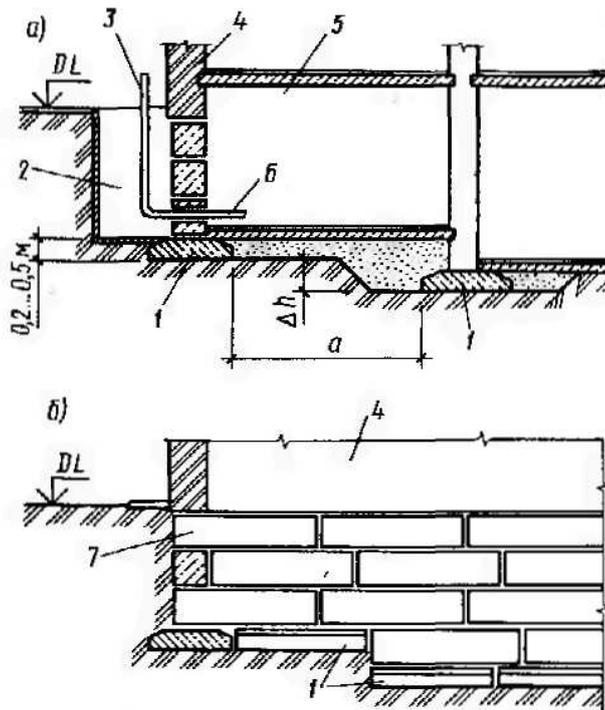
Выбор глубины заложения фундамента в зависимости от конструктивных особенностей сооружения: а – здание с подвалом в разных уровнях и приямок; б – изменение глубины заложения ленточного фундамента; 1 – фундаментные плиты; 2 – приямок; 3 – трубопровод; 4 – стена здания; 5 – подвал; 6 – ввод трубопровода; 7 – стеновые блоки
